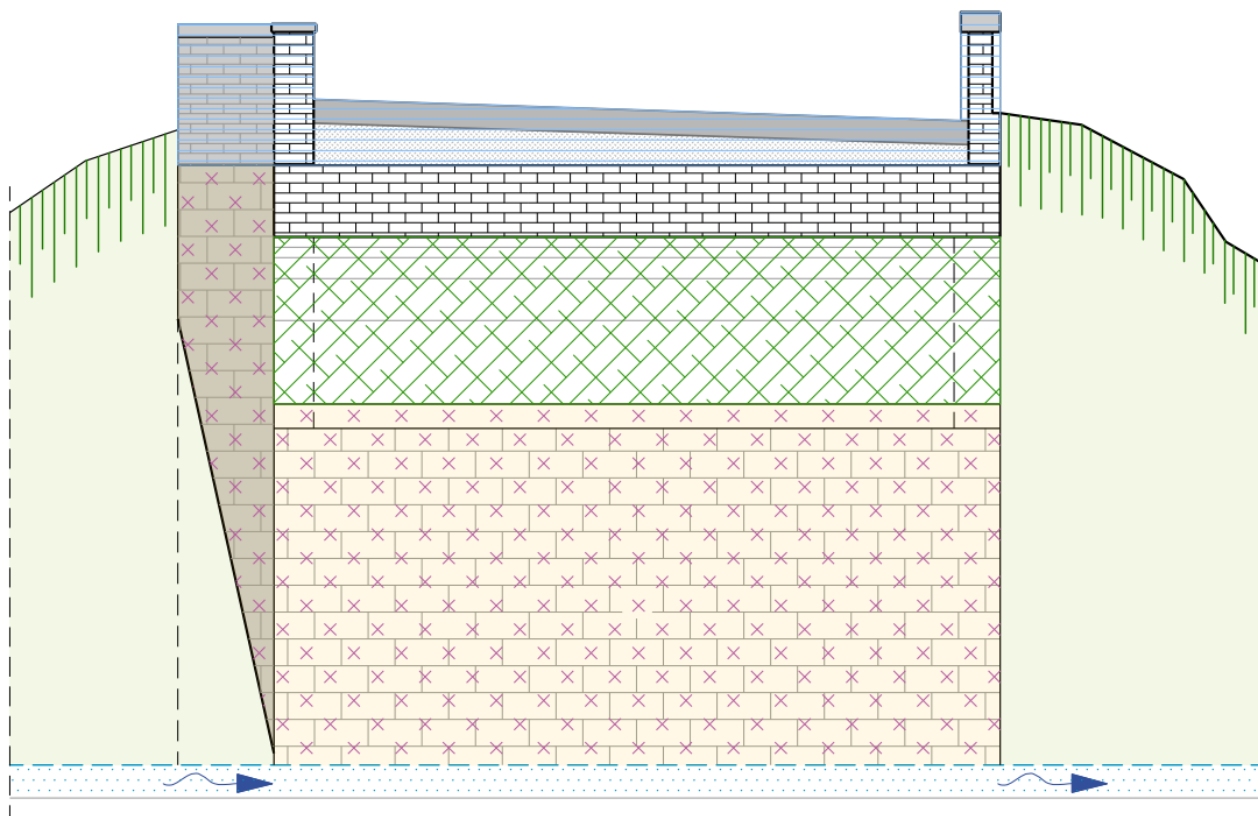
Stato di Progetto – Interventi di consolidamento – Sezione trasversale A-A
